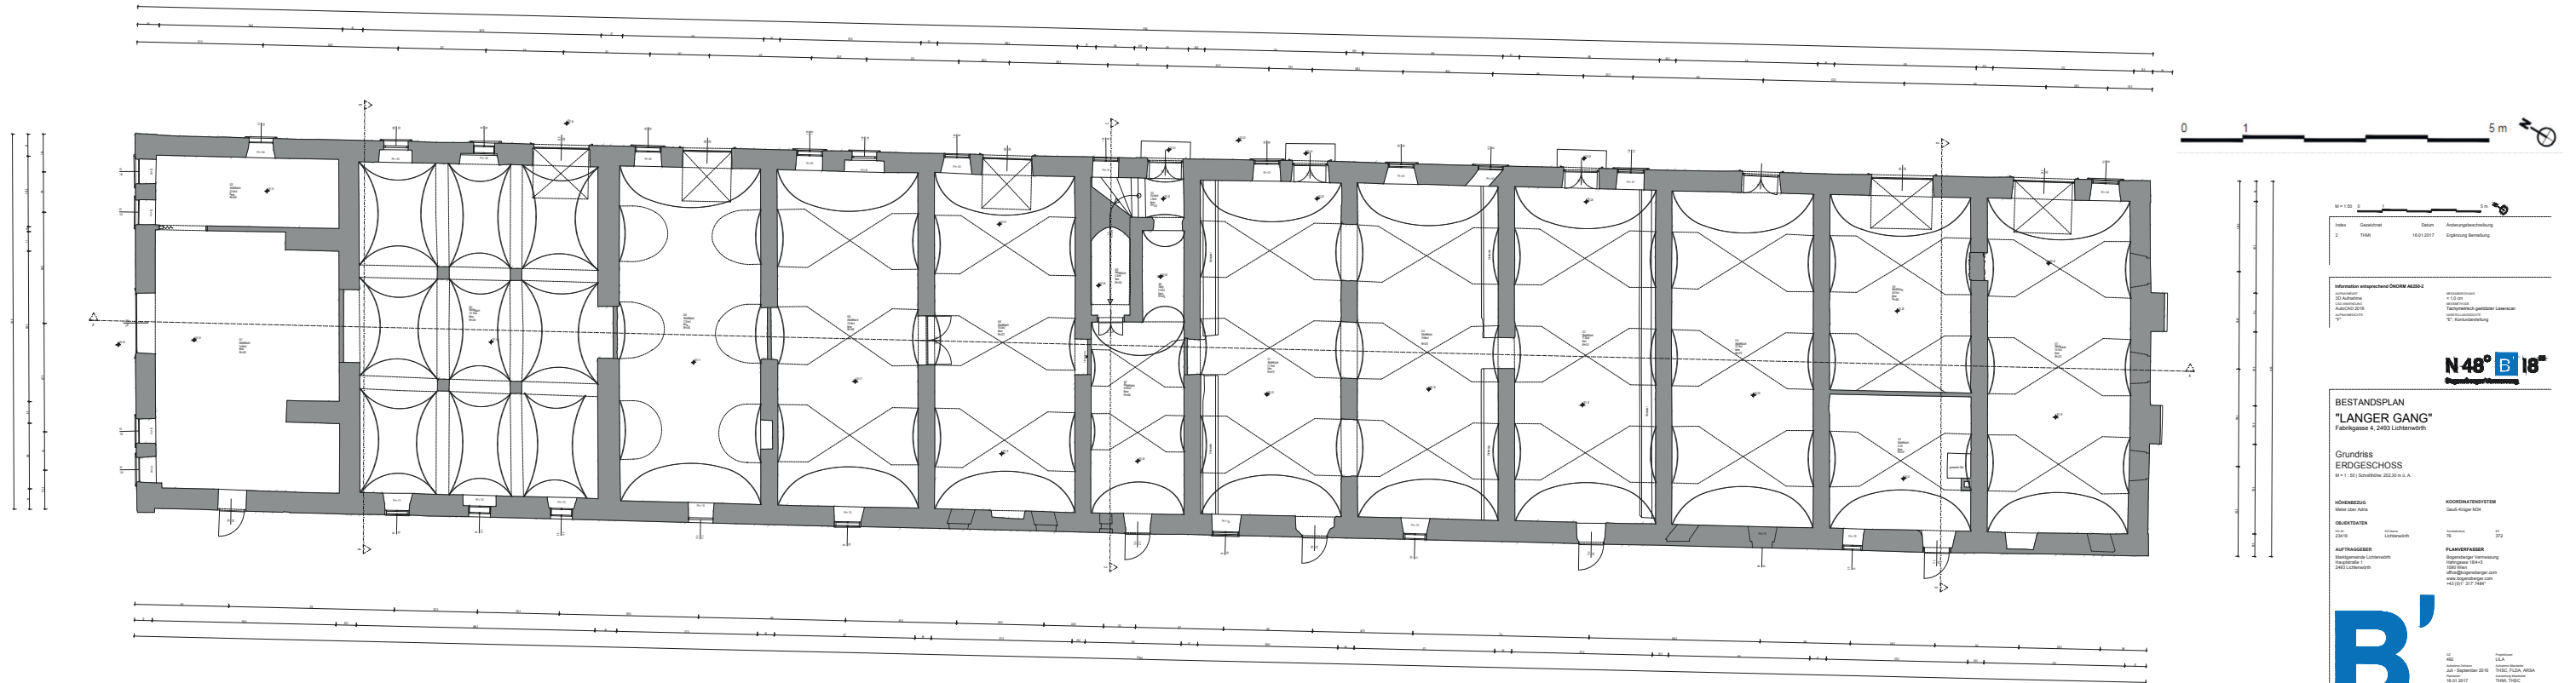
Langer Gang, Grundriss Erdgeschoss, Vermessungsplan 2017.
